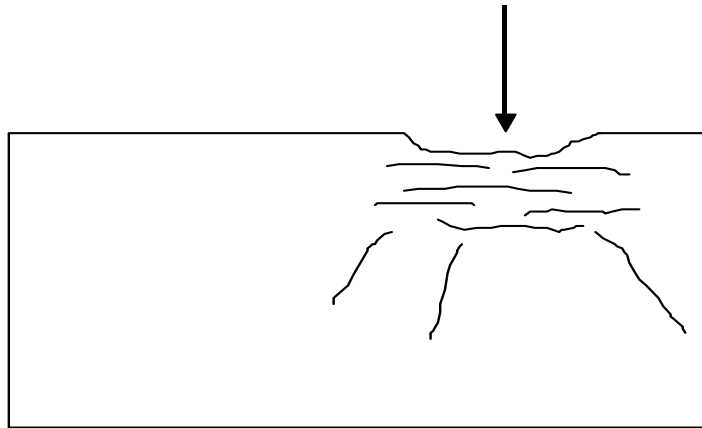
Ruptura localizada da alvenaria sob o ponto de aplicação da carga e propagação de fissuras a partir desse ponto (adaptado de THOMAZ, 1989).
